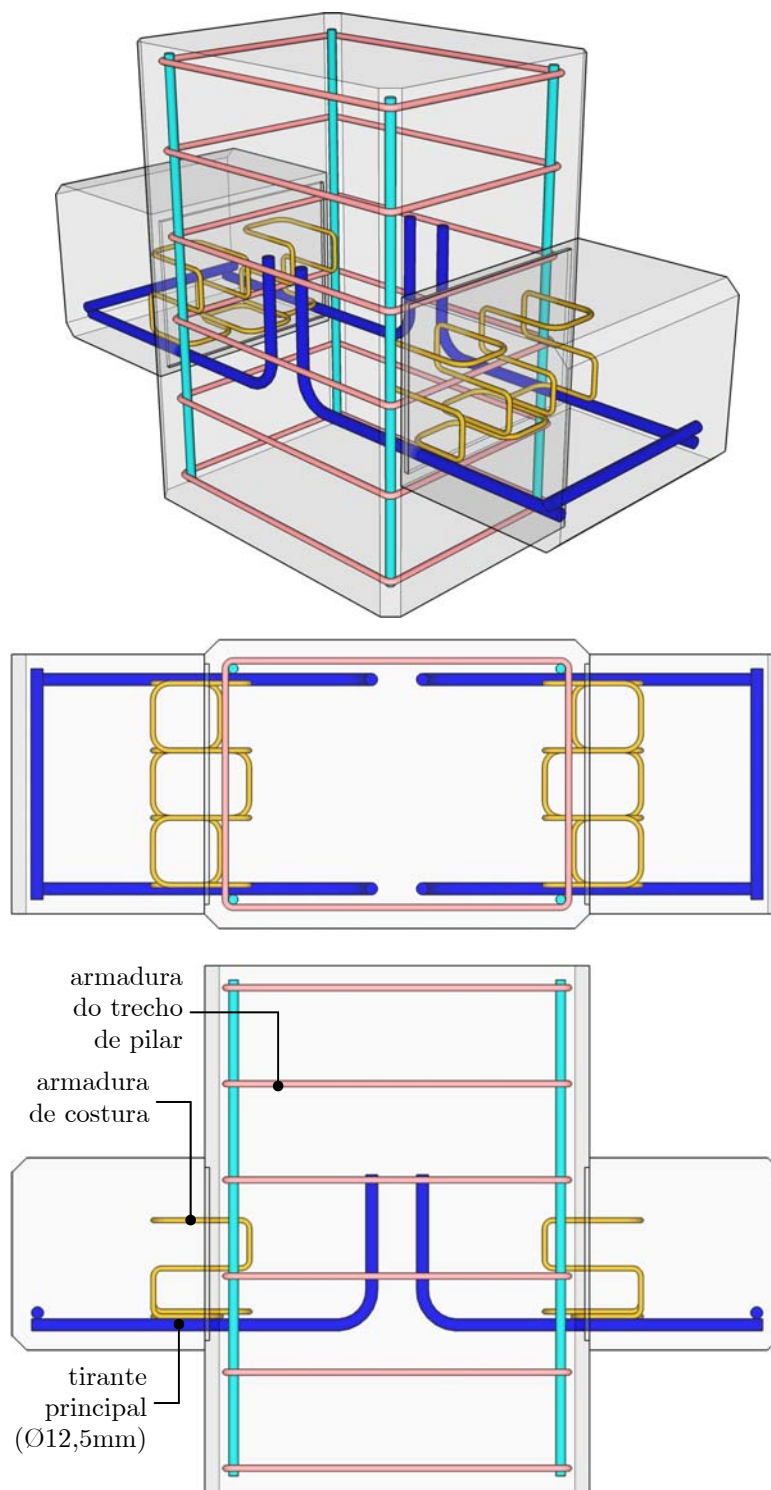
Detalhes das armaduras do modelo MBC2.
